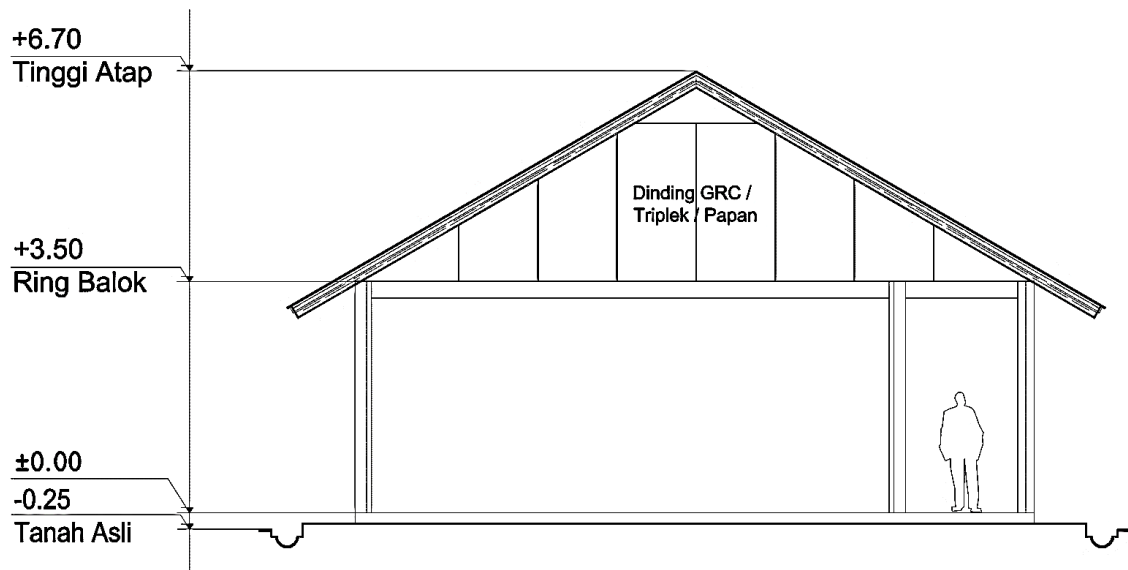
Contoh Tampak Depan Laboratorium Bahasa
